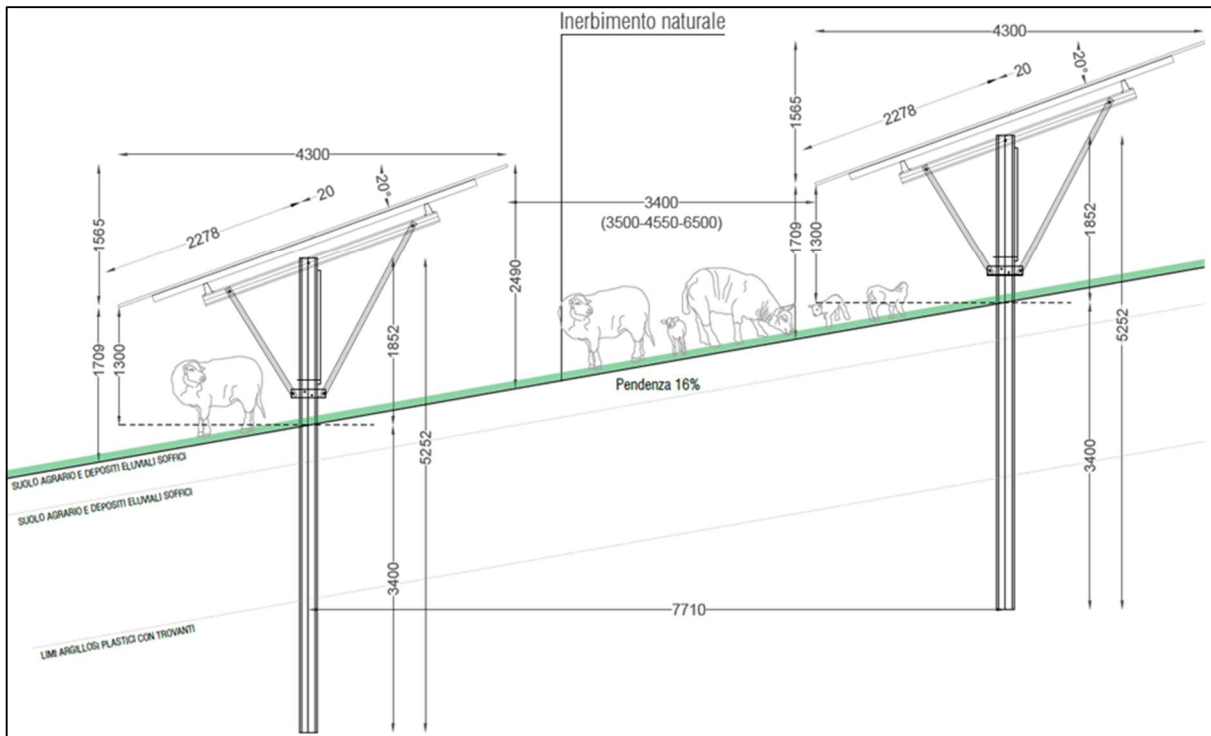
Tipico delle strutture fisse con altezza min dal suolo pari a 1,30 m
